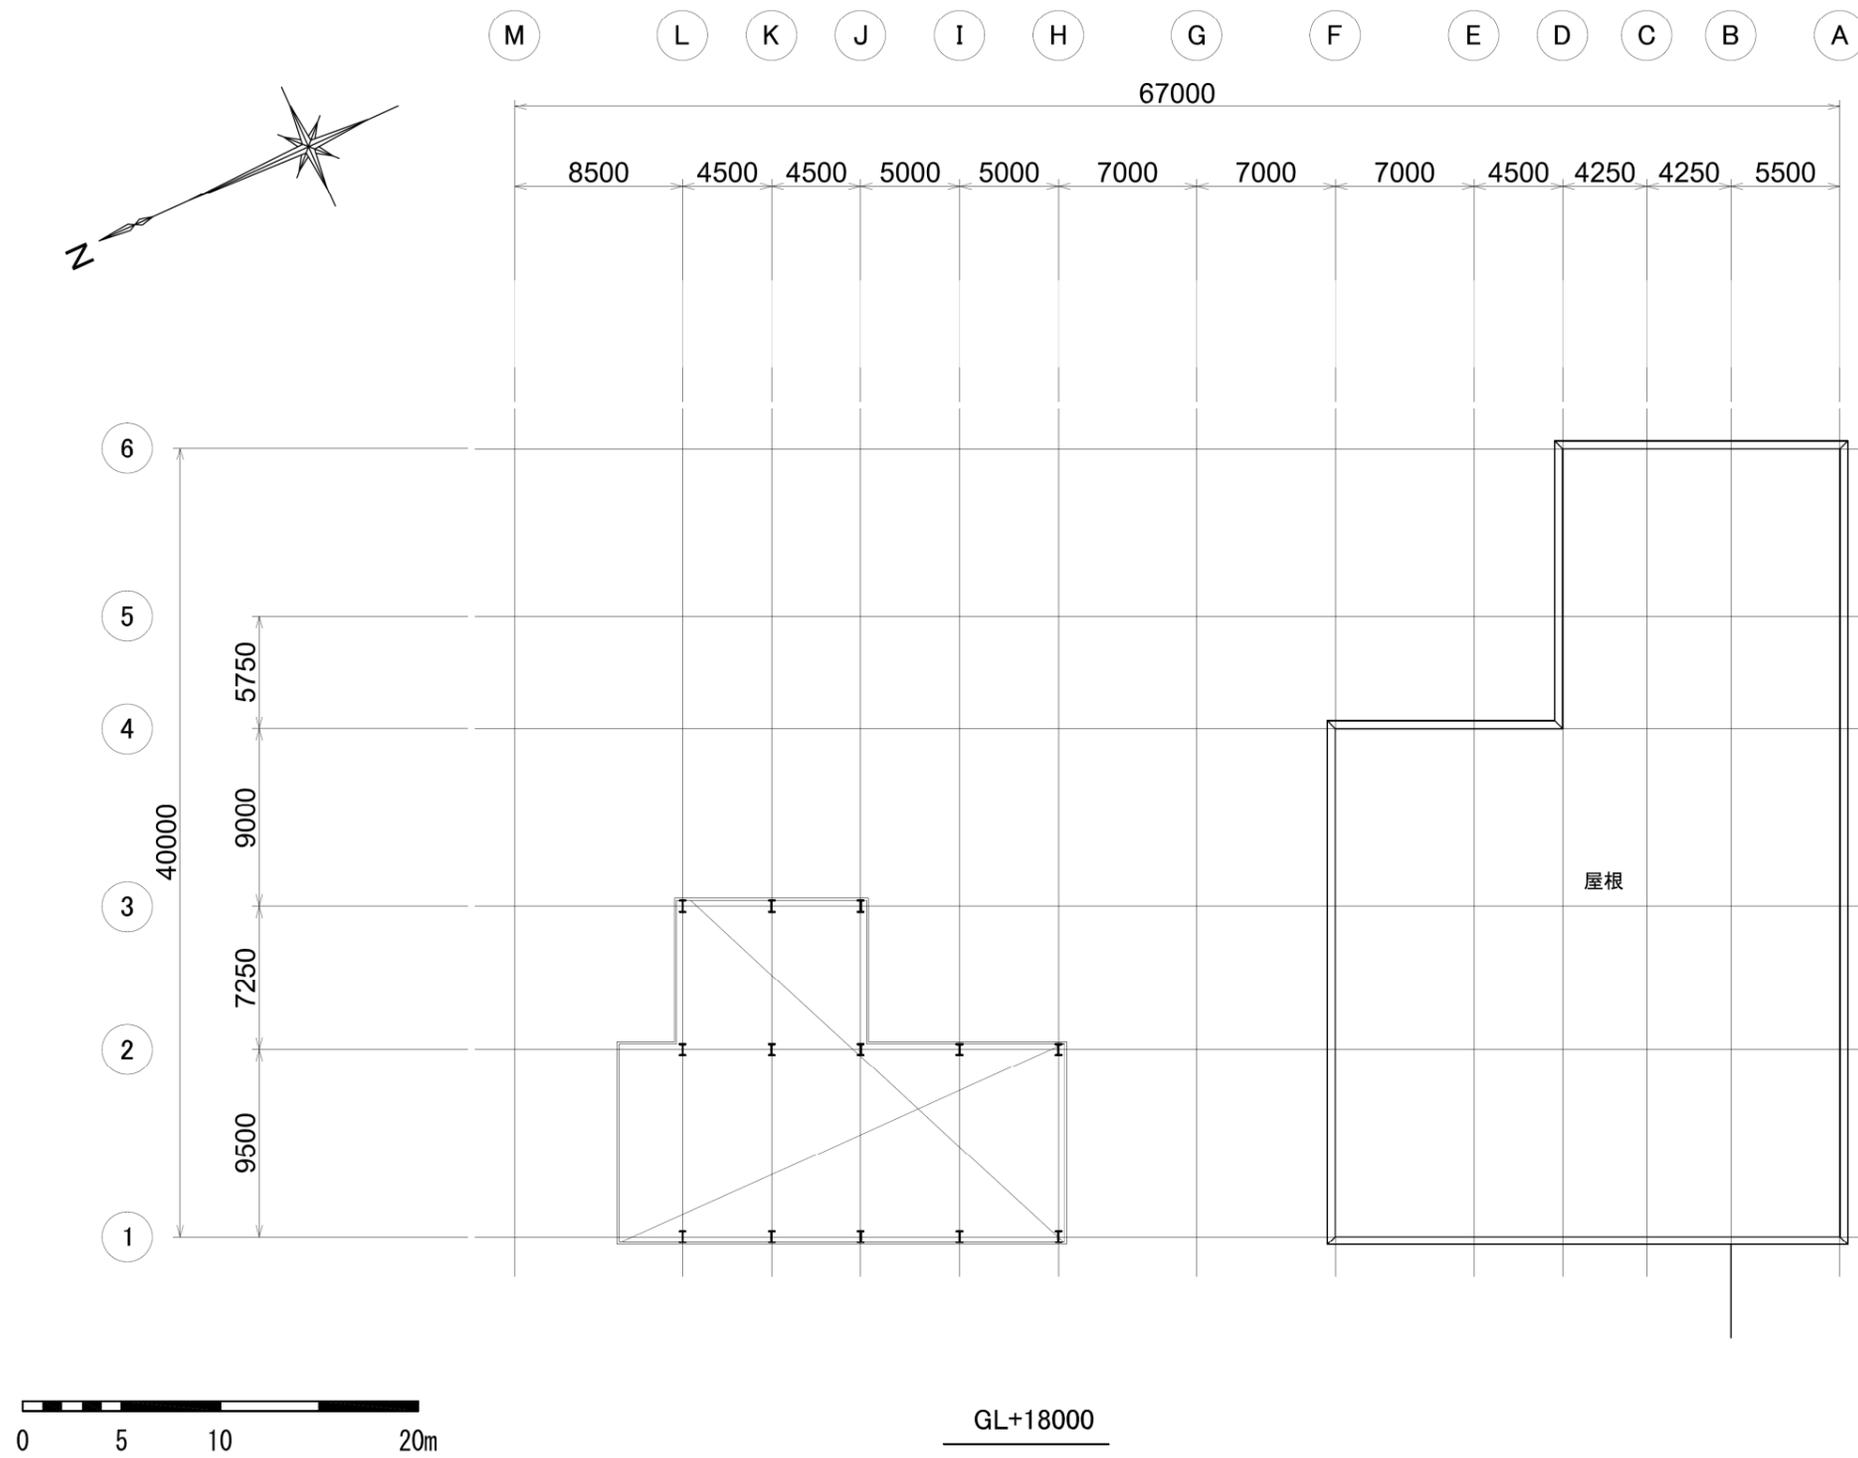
リサイクル処理棟各階平面図 (GL+18000)
